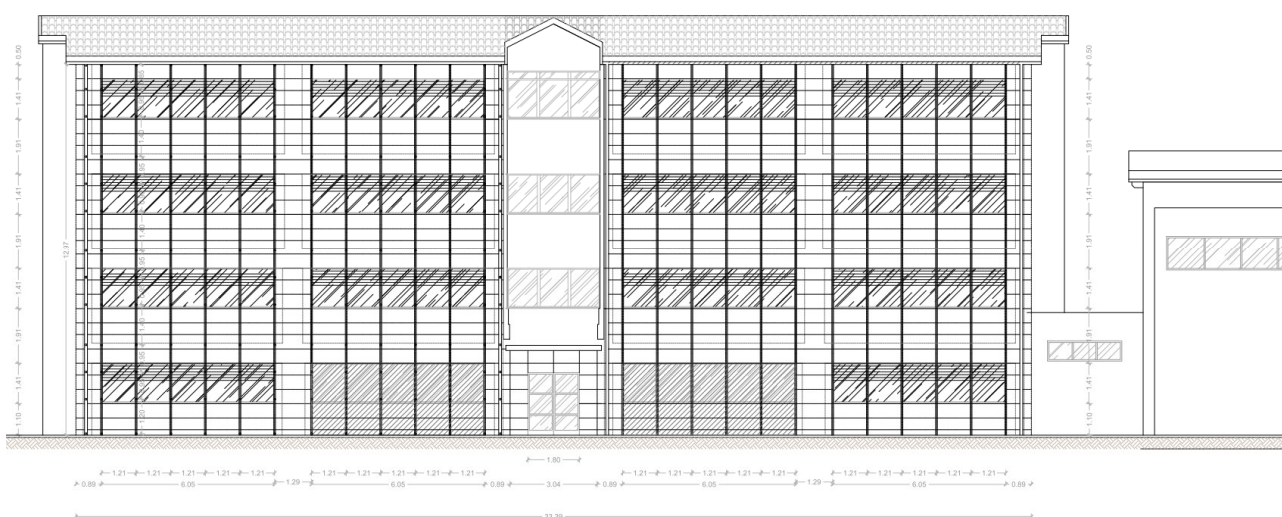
Stralcio Prospetto Sud con schema struttura facciata ventilata
